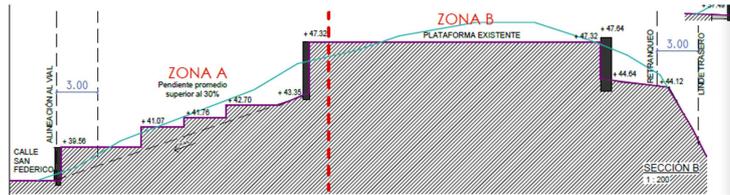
Sección transversal de parcela indicando Zonas A y B
